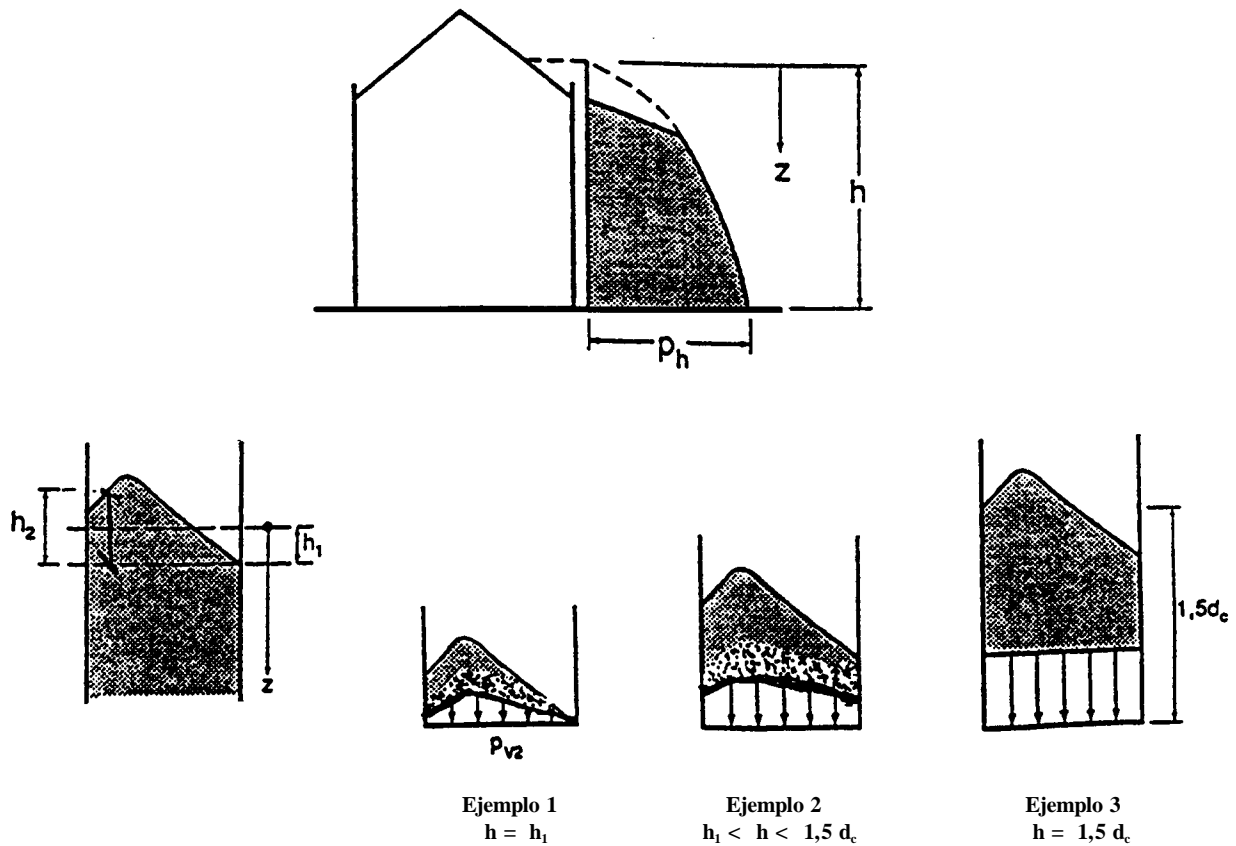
Cargas sobre las paredes y fondos planos en silos cortos
